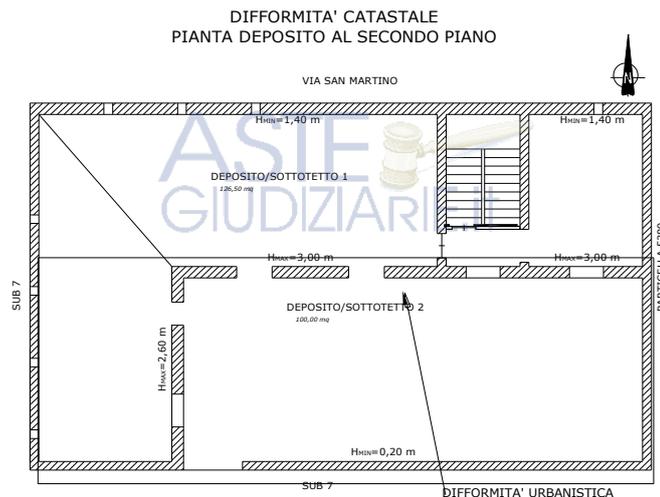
planimetria delle difformità urbanistiche del deposito sottotetto al secondo piano rispetto alla L.E. n.4545/1977 del 21/04/1977
